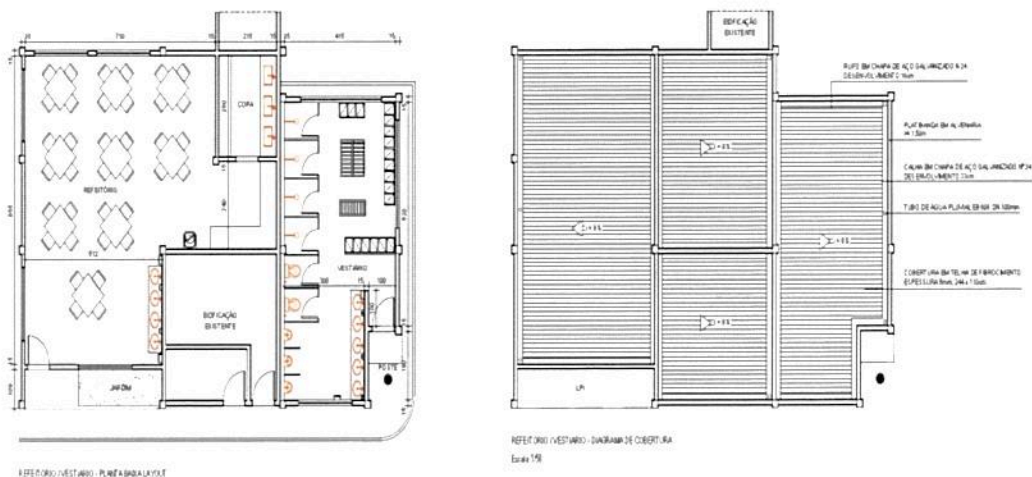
Planta baixa e de cobertura do vestiário e refeitório.
